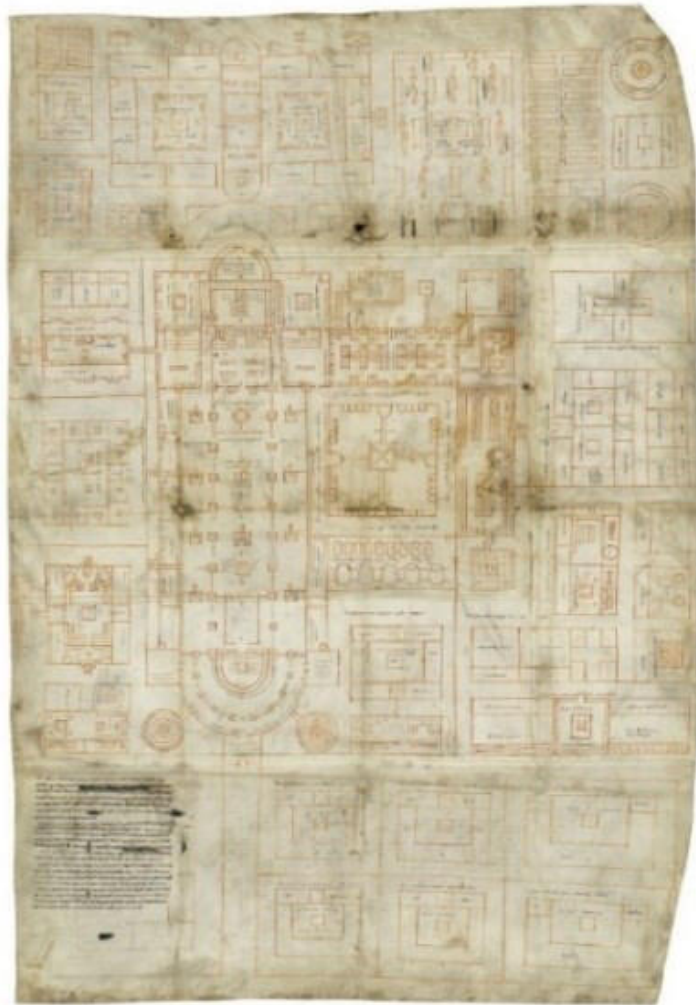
Plano desenhado para a abadia de Saint-Gall. Fonte: <https://www.stiftsbezirk.ch>
